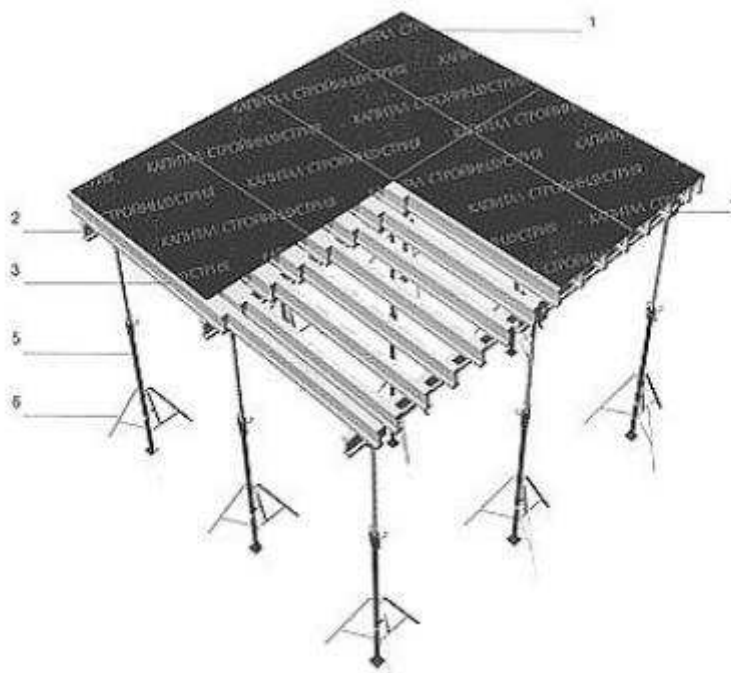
Схема расстановки опалубочной системы перекрытия:
